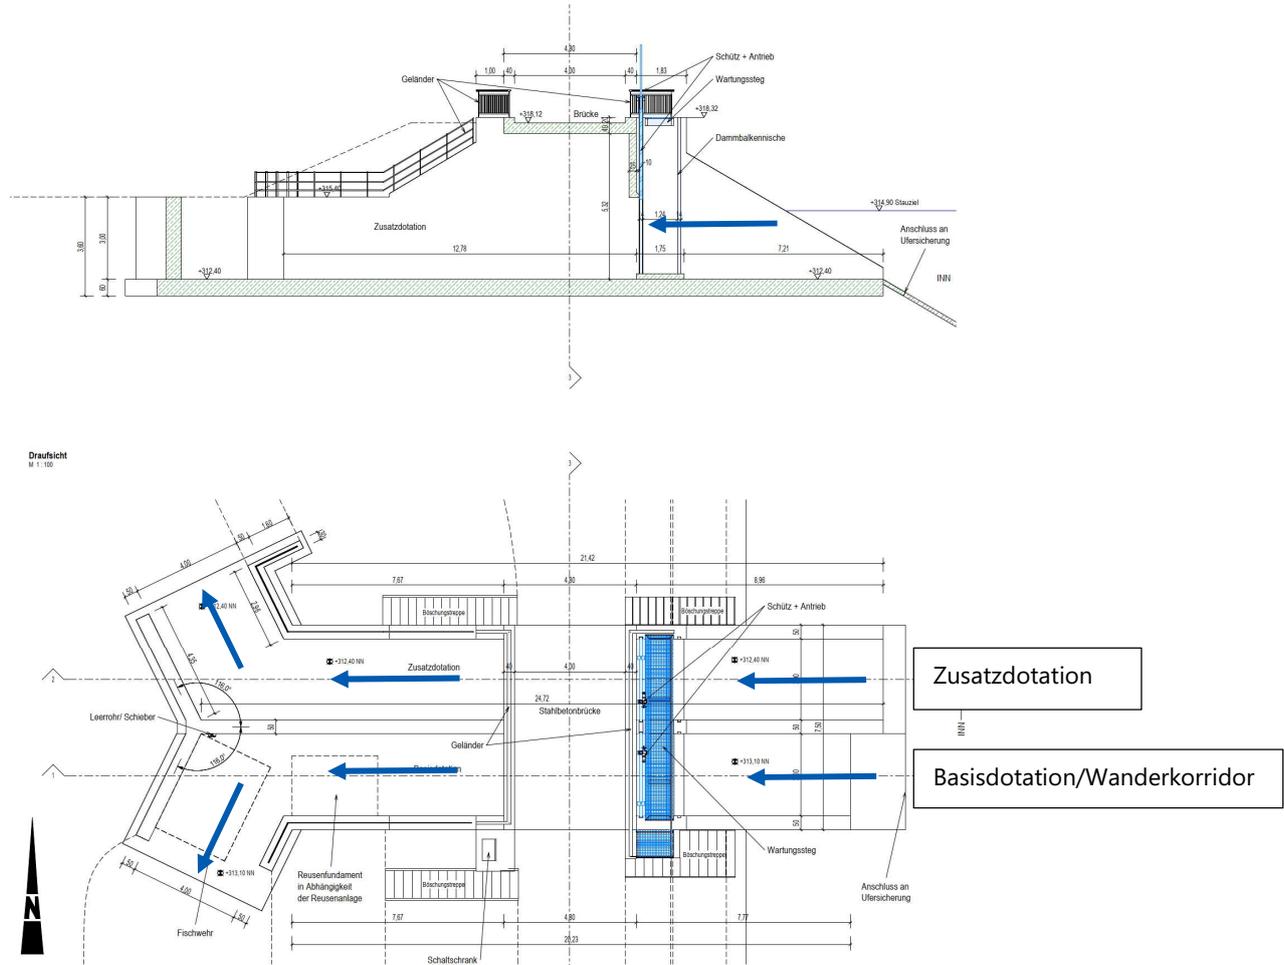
Planausschnitt Ausstiegsbauwerk
